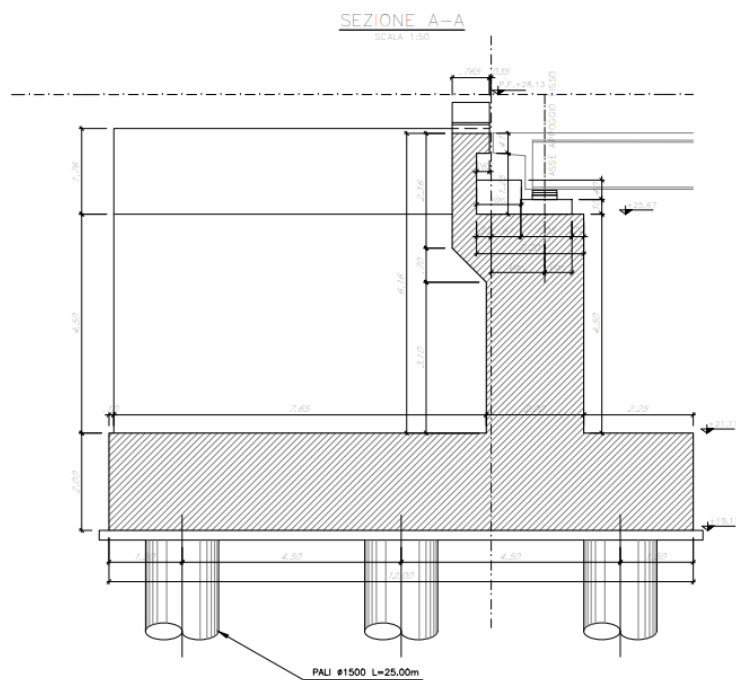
Sezione longitudinale Spalla A
